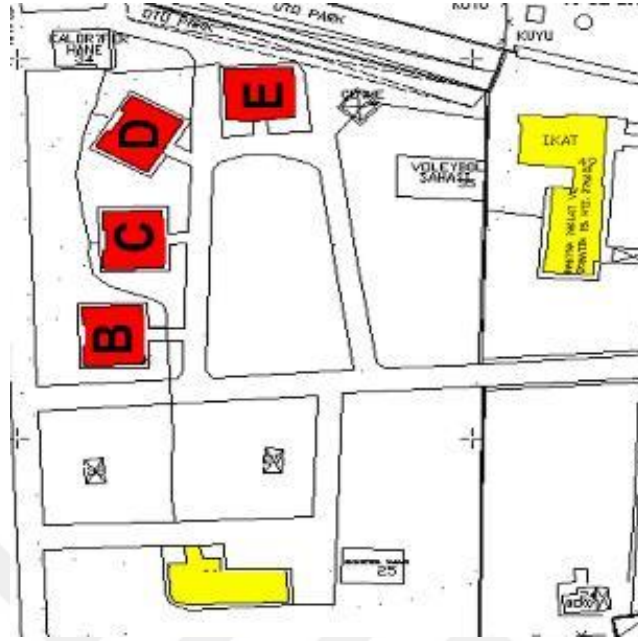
DSİ Makina İkmal Kampüsü Vaziyet Planı
